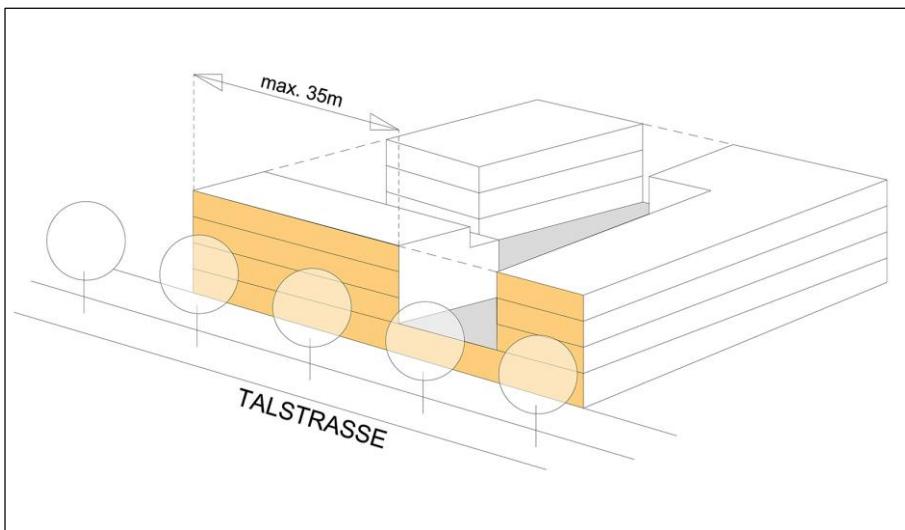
Schematische Darstellung zur abweichenden Bauweise „a3“
